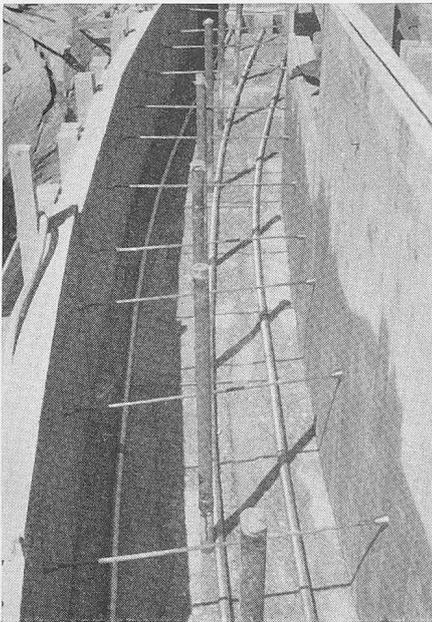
Câbles horizontaux dans la partie mince du barrage. On distingue les tubes de passage des câbles verticaux
